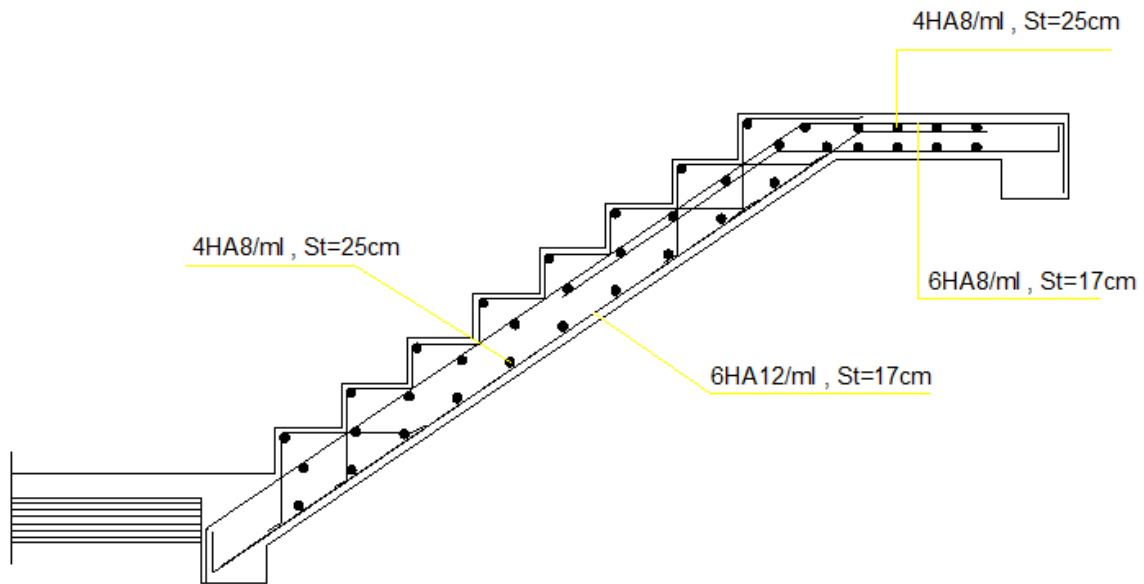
Schéma de ferrailage de l'escalier de RDC
